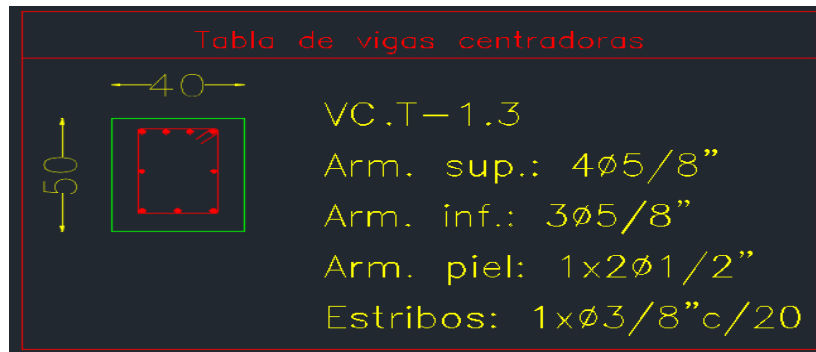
Distribución de aceros vigas de cimentación. Fuente: planos estructurales
